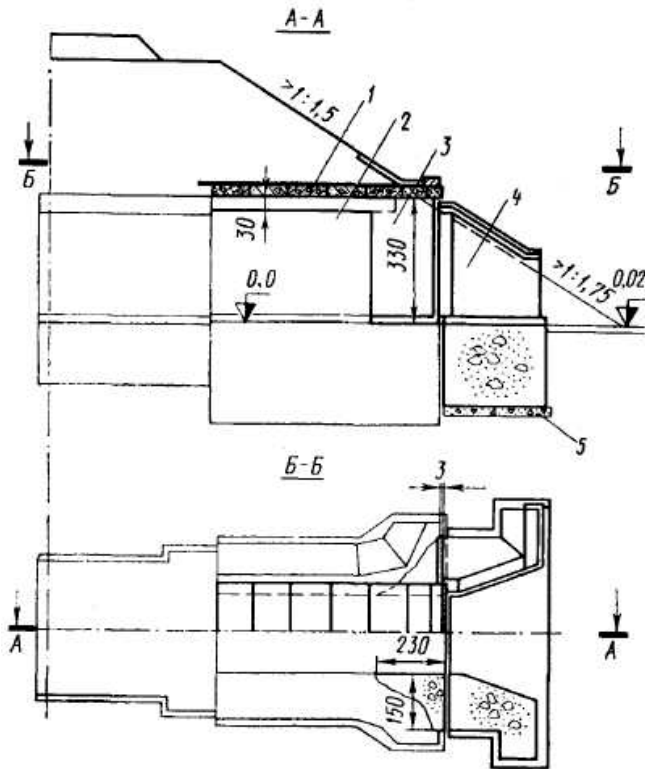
Удлинение оvoidальной трубы с устройством нового оголовка (размеры в сантиметрах): 1 – железобетонные плиты перекрытия; 2 – стенки существующего оголовка; 3 – добетонированные части стенок; 4 – новый входной оголовка; 5 – щебеночная подготовка
